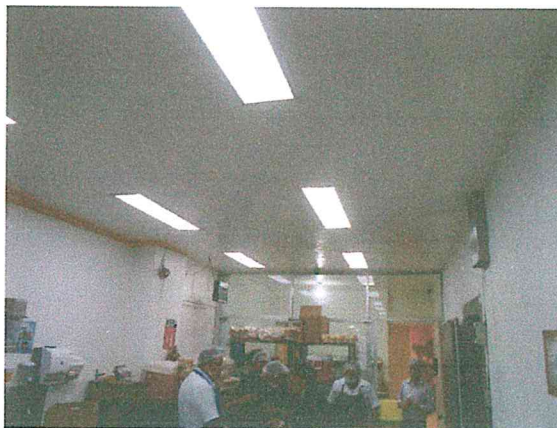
y 8. Muros y plafones del área de cocina, sin afectación estructural.
